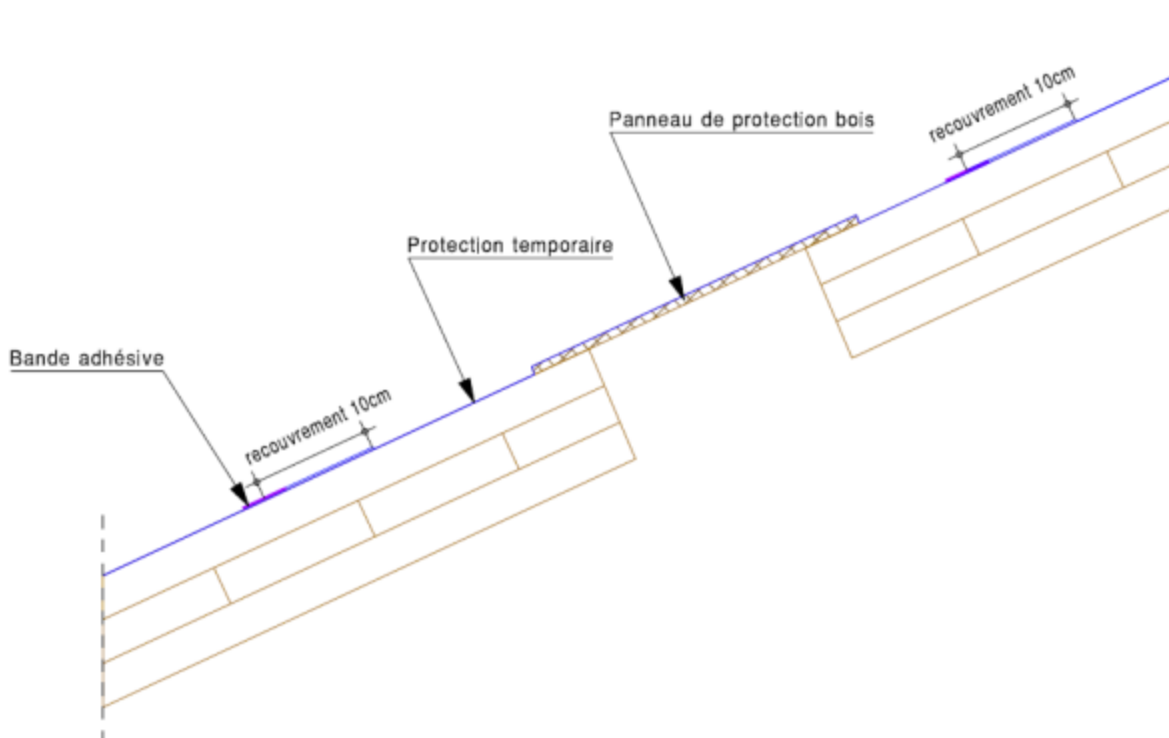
Mise en œuvre de la protection provisoire par écran souple section courante
